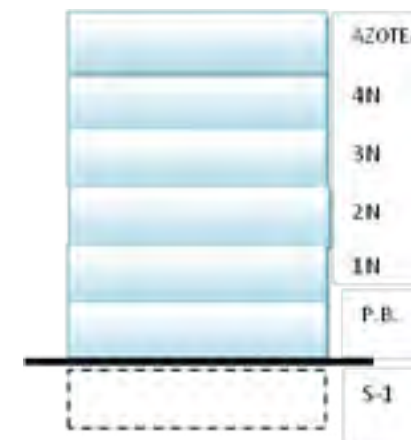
Corte esquemático, plantas tipo ESDA, París.
